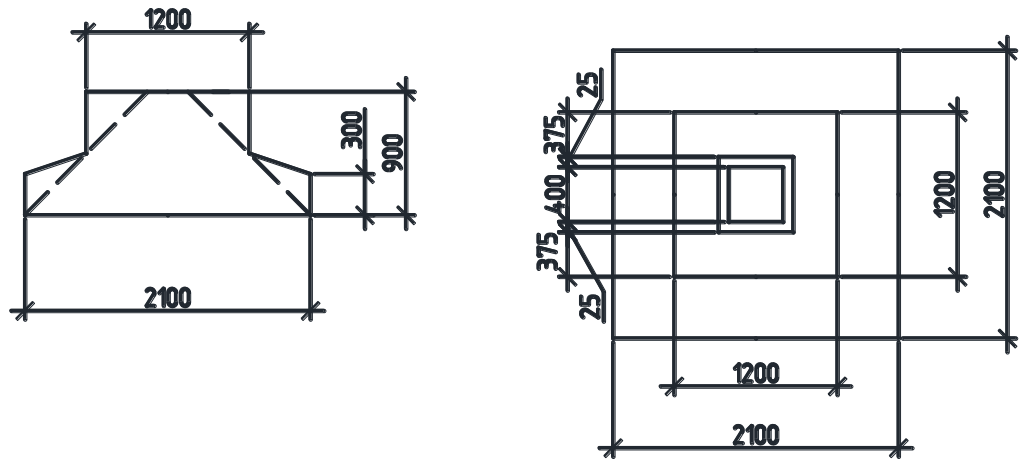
Схема монолитного железобетонного фундамента под колонну.
